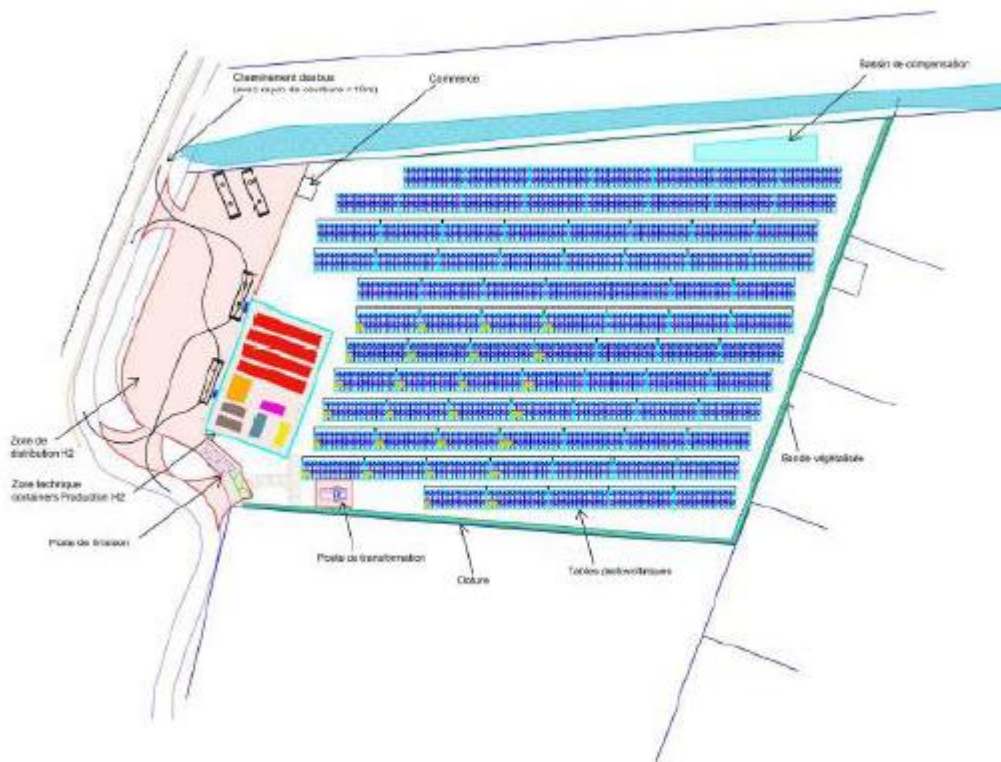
Plan masse du parc photovoltaïque (Source : dossier PC)
